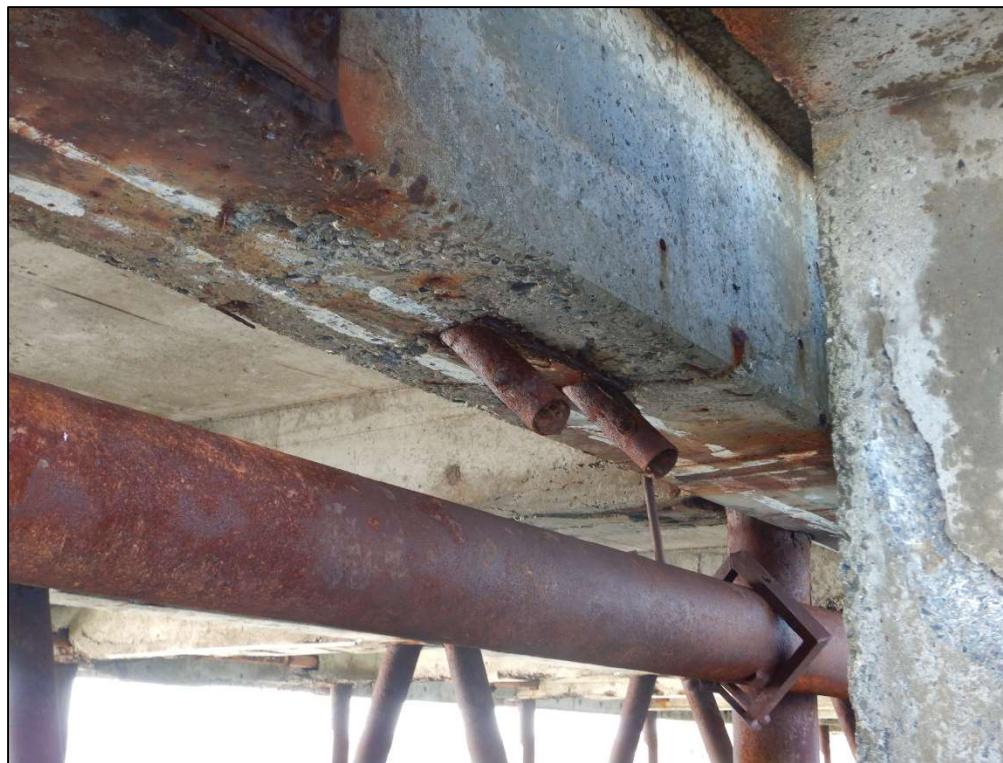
TRAVÉE N°52 – ANCRAGES D'UNE ÉCHELLE MANQUANTE
